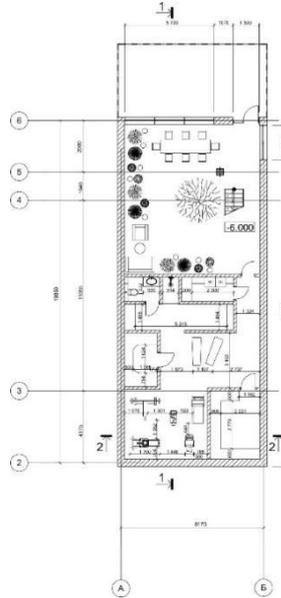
План -2-го этажа с расстановкой мебели на отметке -6.600
